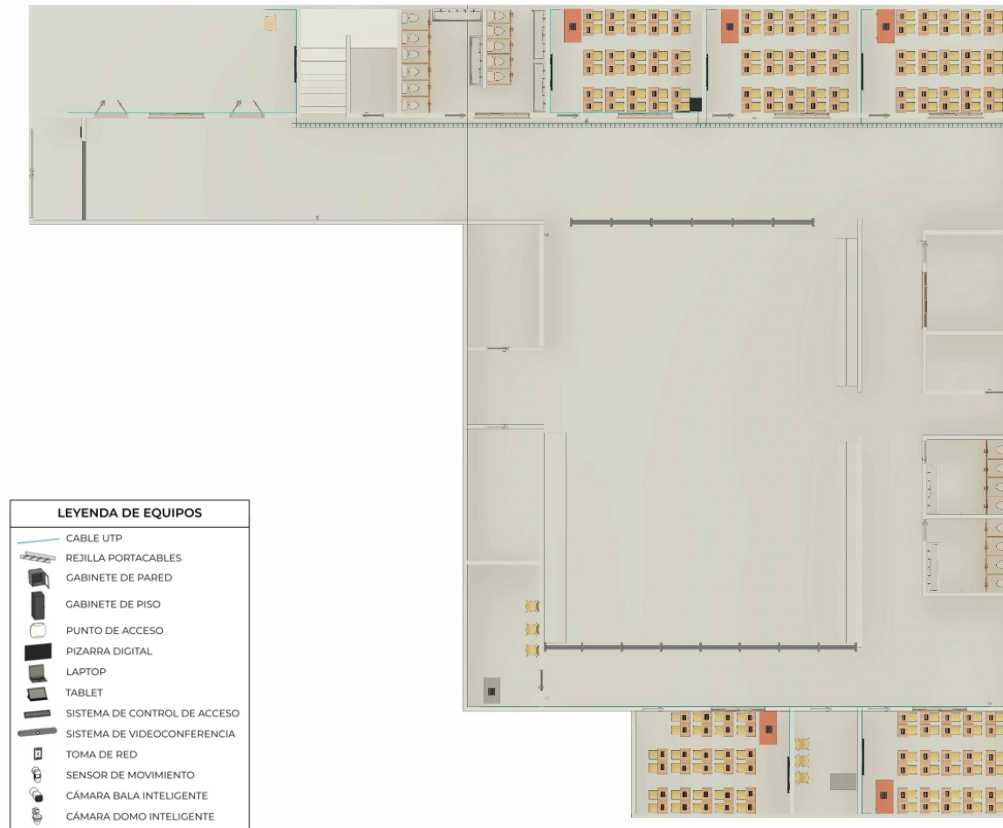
Plano 2D con equipos de la planta inferior (con único acceso al coliseo)
